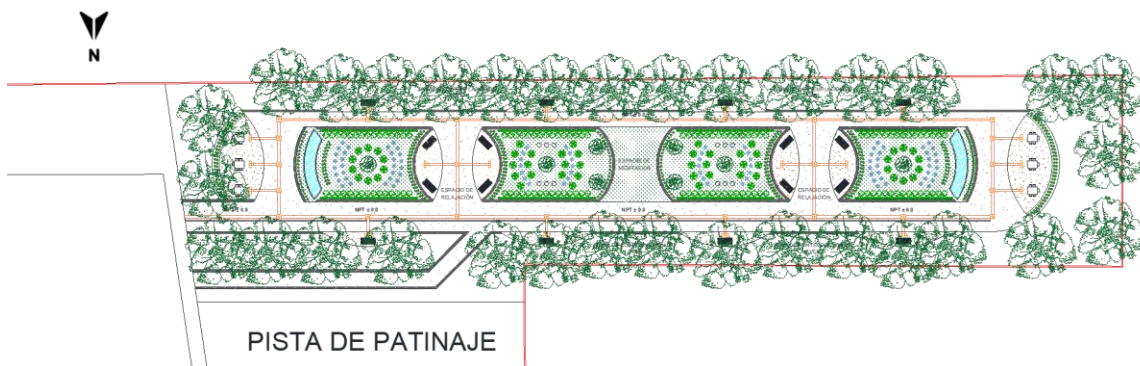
Propuesta de planta arquitectónica para la segunda sección de la Zona de Meditación. Fuente: Elaboración propia con base en Google, 2024.
